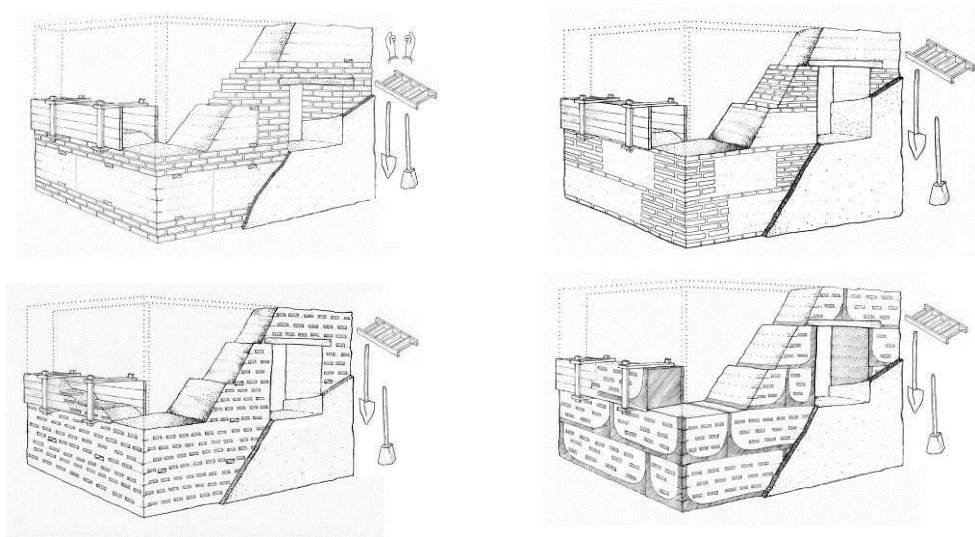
Detalles constructivos: tapia con diferentes tipo de refuerzo con ladrillos (García-Cristini-Tibor 2011)
